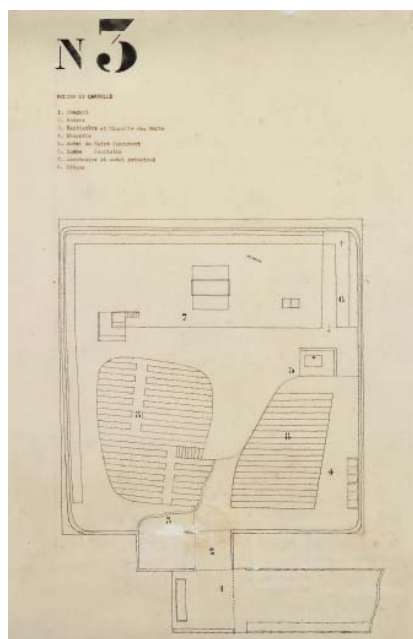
Dibujo planta nivel 3, perteneciente al proyecto final. Fuente: FLC. 16530A (nivel 3)
